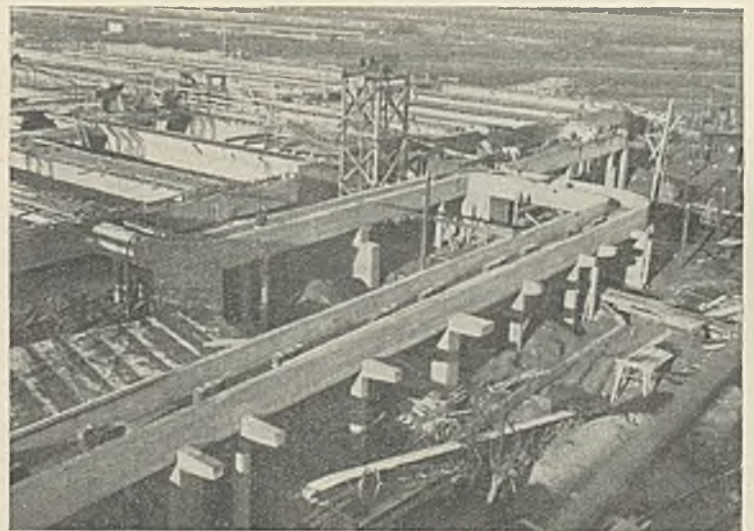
Eisenbetonkonstruktionen der Zulaufrippen für die Belebzanlage.
